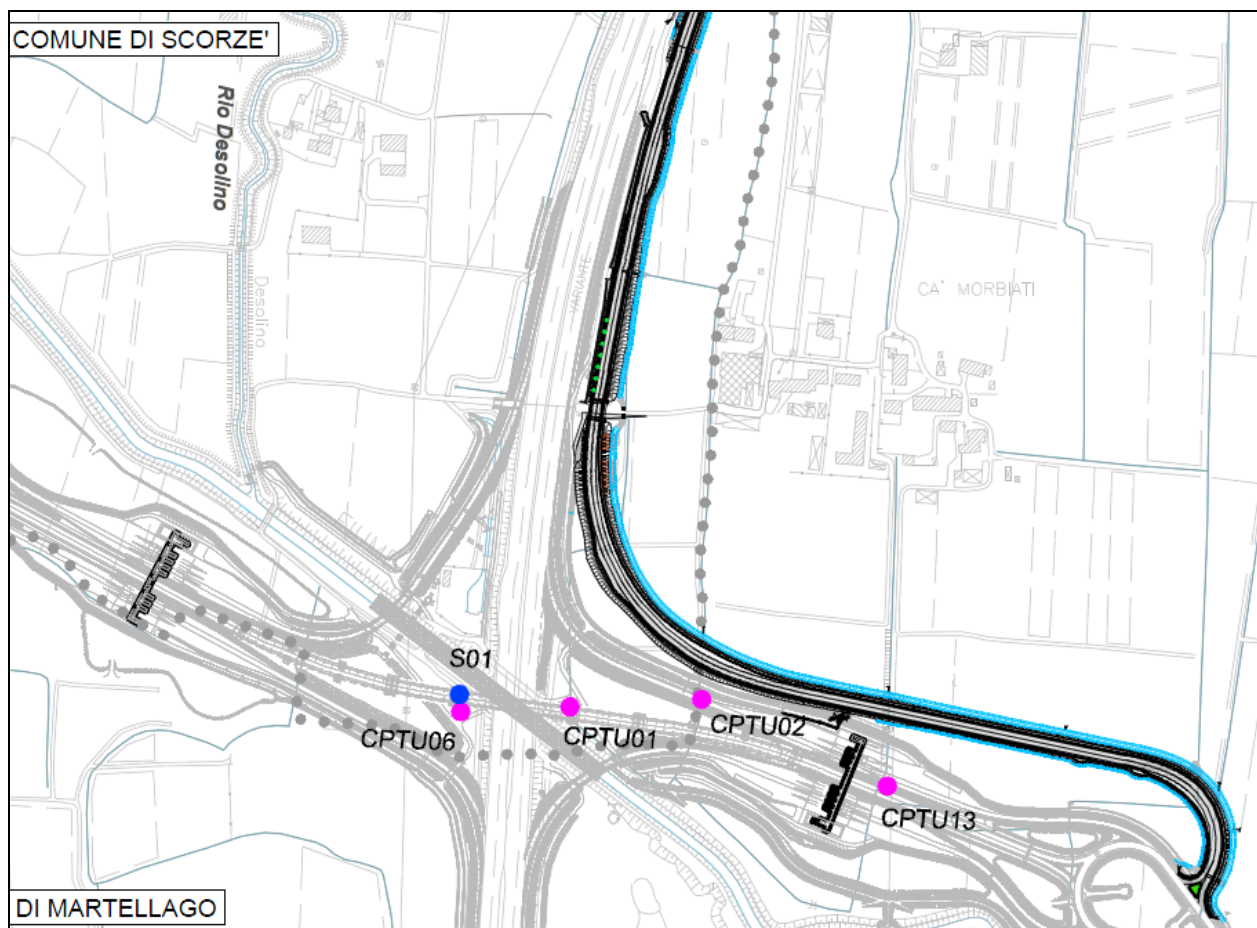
Planimetria con ubicazione delle indagini eseguite
